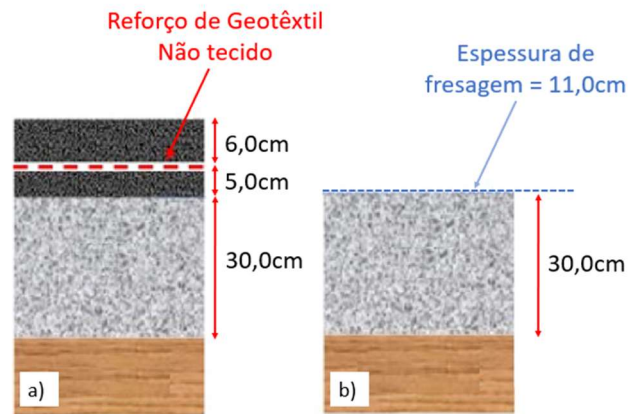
Perfil do pavimento existente e localização do reforço. Fonte: Adaptado de Saxena et al. (2023).
